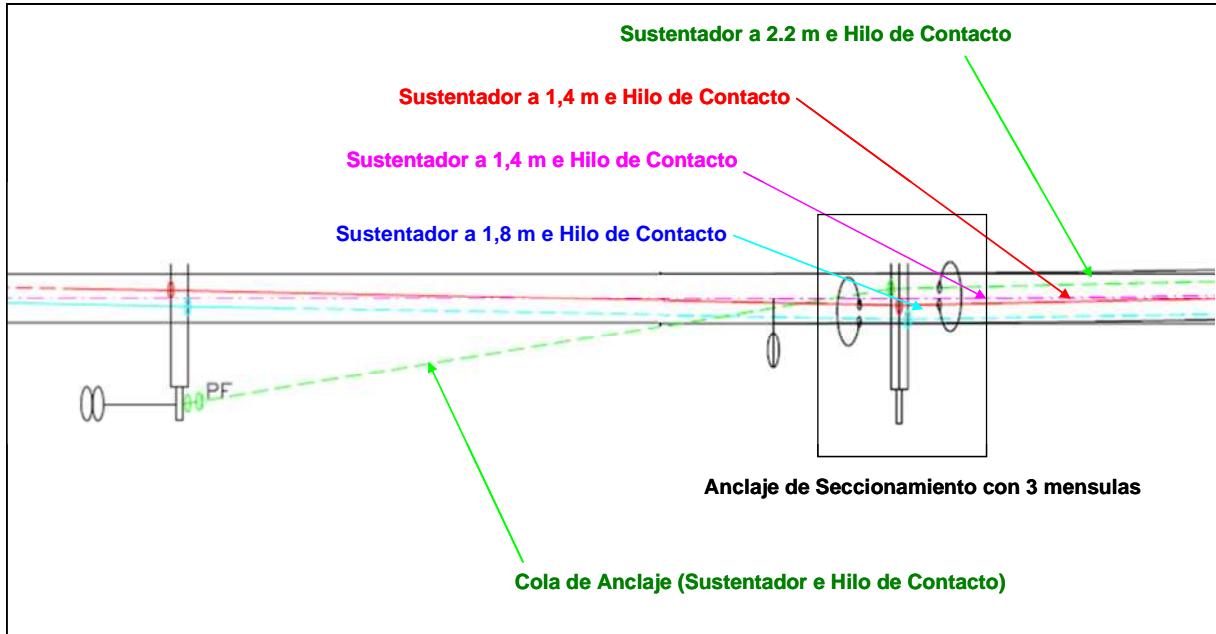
Cables que sustenta el anclaje de seccionamiento con tres ménsulas
